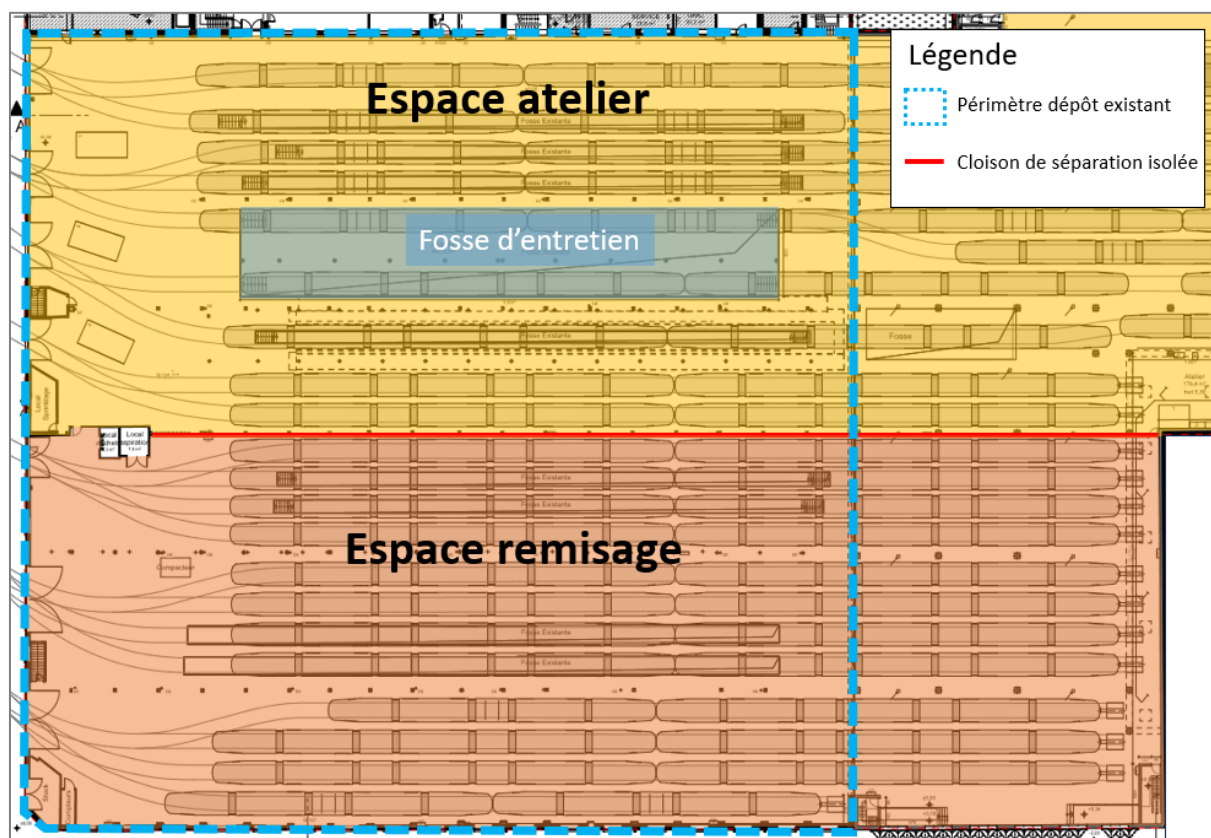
Plan du rez-de-chaussée au niveau du périmètre du dépôt existant (source : Architecte)
